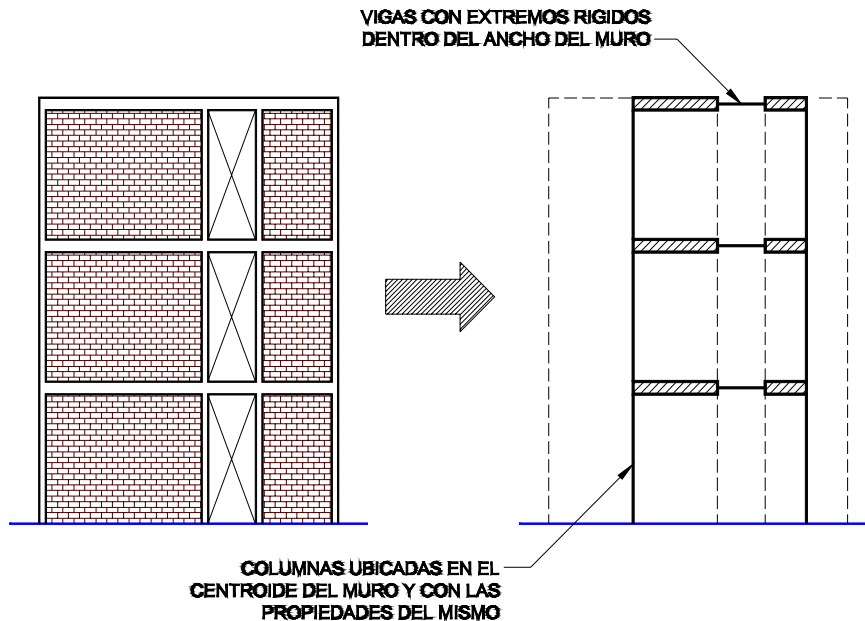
Modelo muro mampostería confinada con el método de columna ancha
